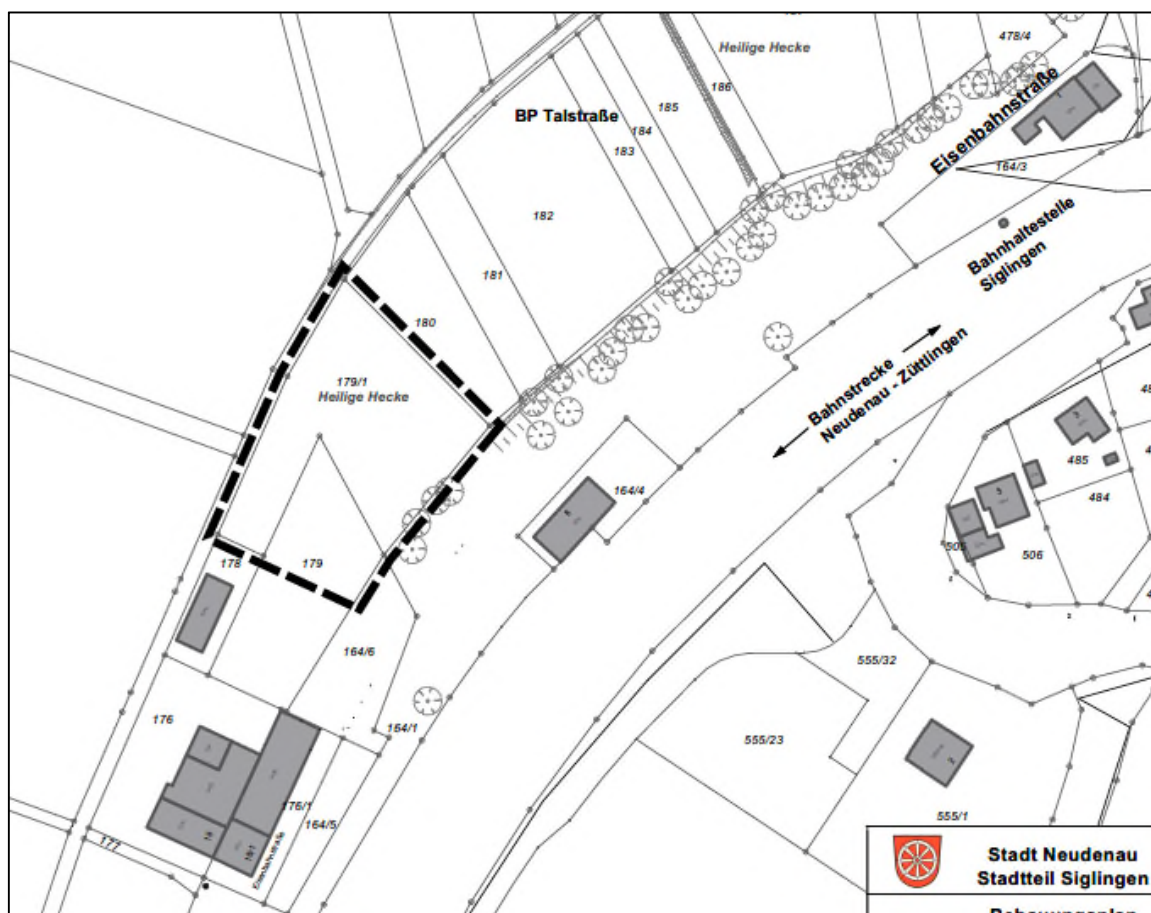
Abgrenzungsplan Bebauungsplan „Heilige Hecke I“ [16]
